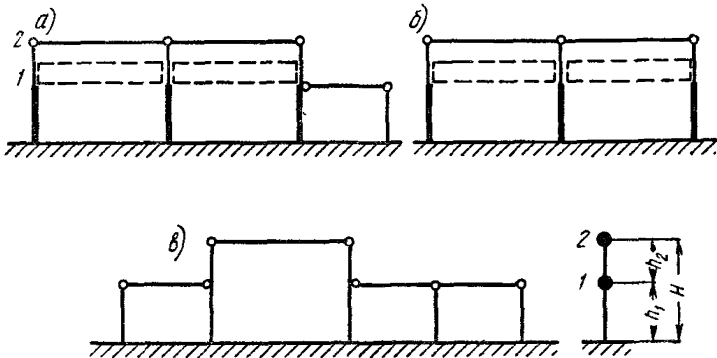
Схемы одноэтажных рам с шарнирными узлами, у которых нижние ригели (или мостовые краны) опираются на каждую стойку
